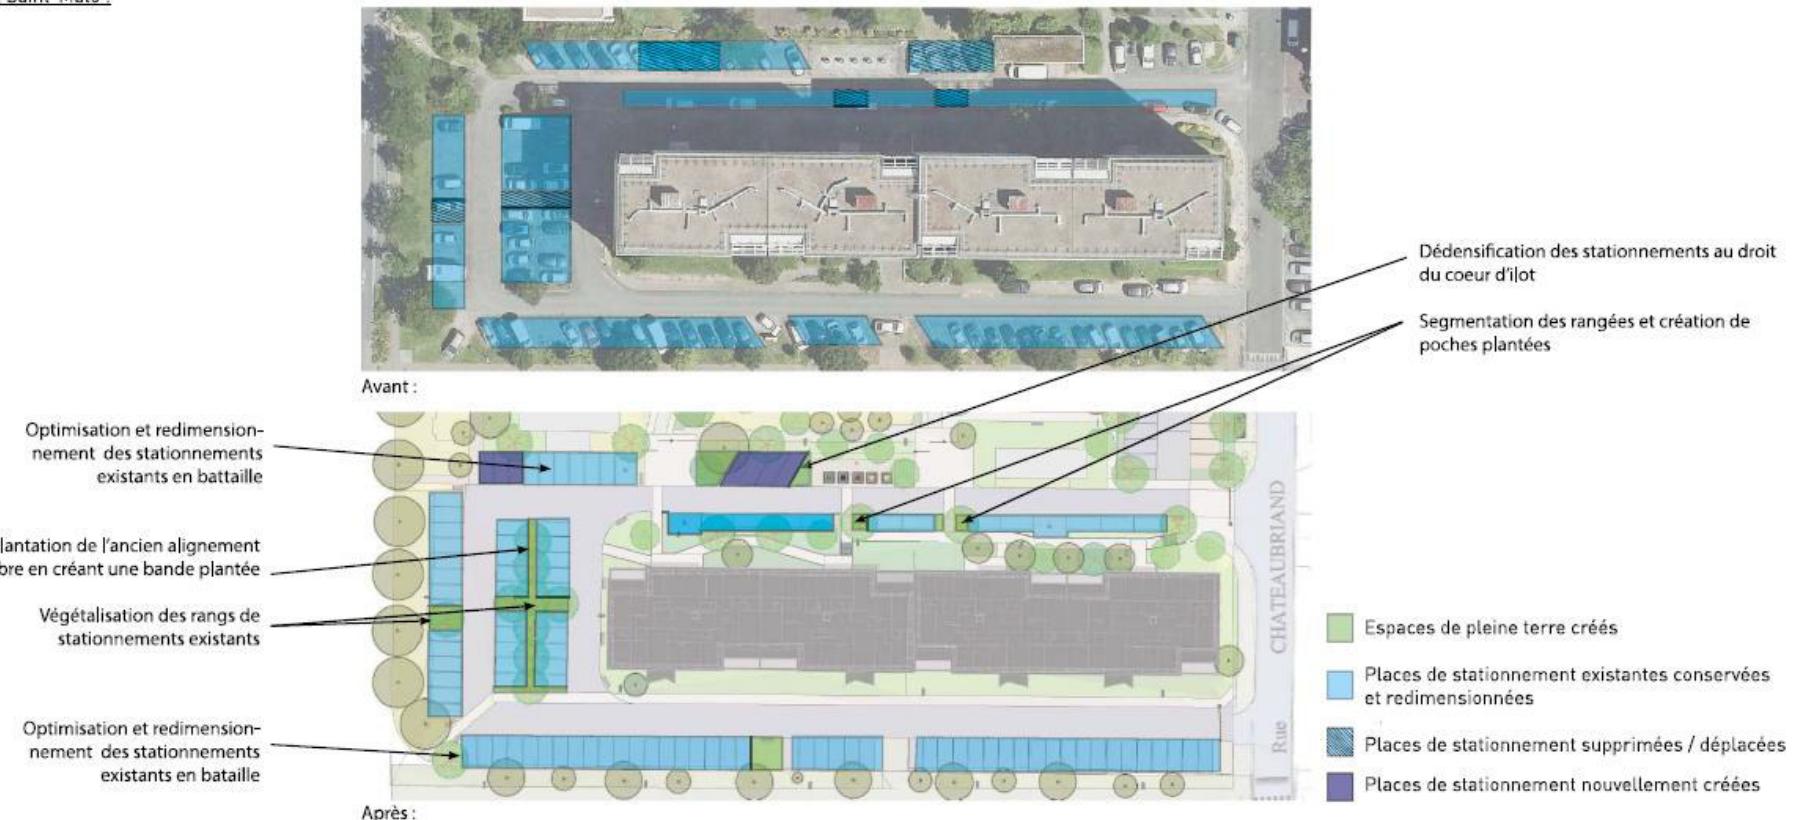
Modification des places de stationnement au droit du parking Saint-Malo – Ilot Nord (Source : Land'Act, 2025)
